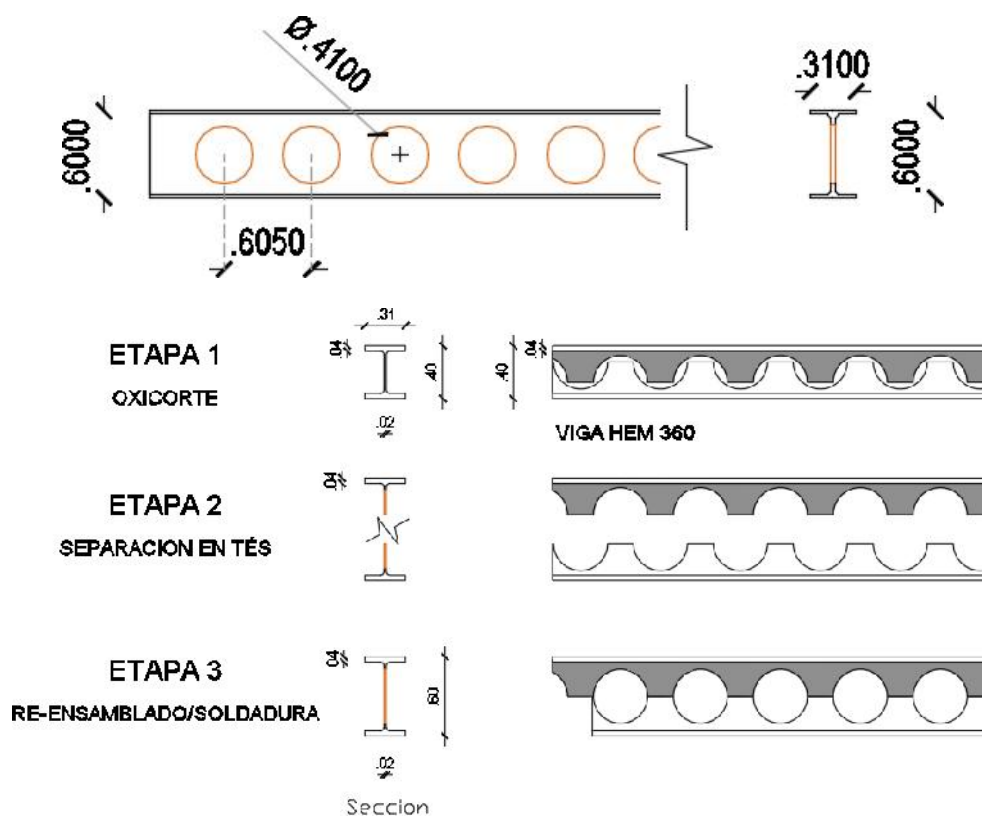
Esquema de fabricación vigas alveoladas Boyd o alveolar.
